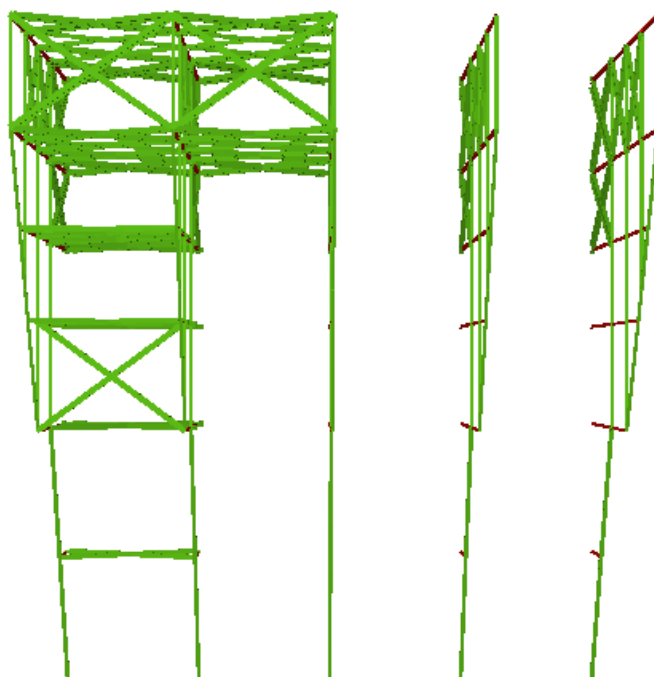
Planta Módulos tipo A con arriostramientos
